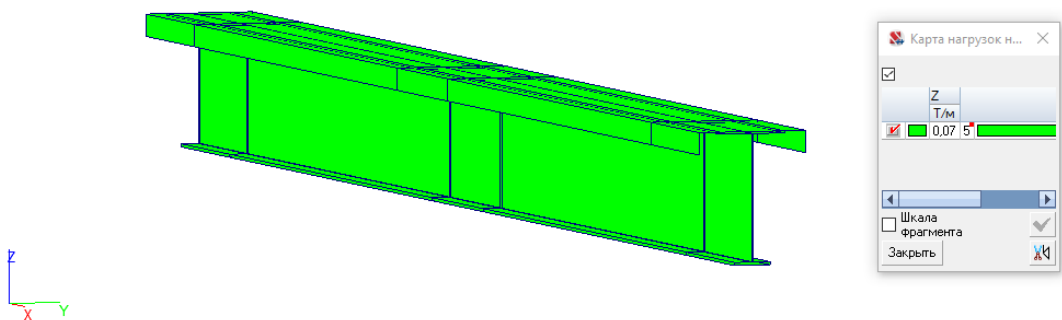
Нагрузка на балку от рельса КР65 (т/м).
